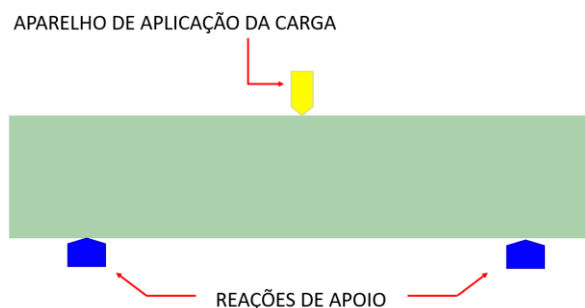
Vigas prismáticas e condições de contorno (Ramírez et al. 2022, Adaptado).
